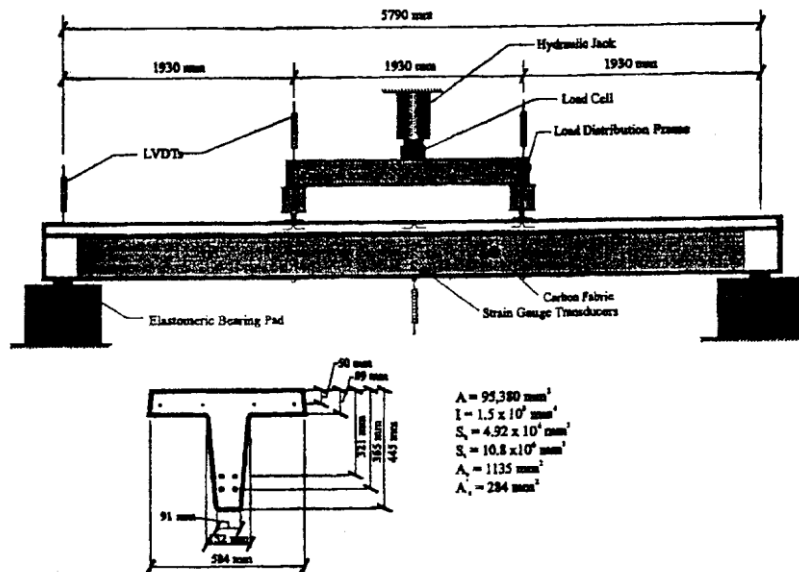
Dimensions des éprouvettes (d'après [57])
